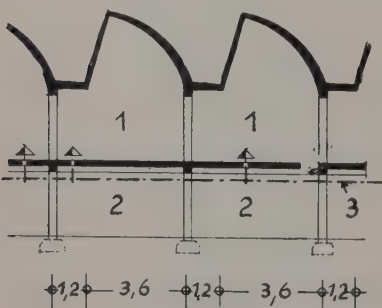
Erdgeschossige Sheddachkonstruktion mit darunterliegenden Installations- und Lagerkellern
